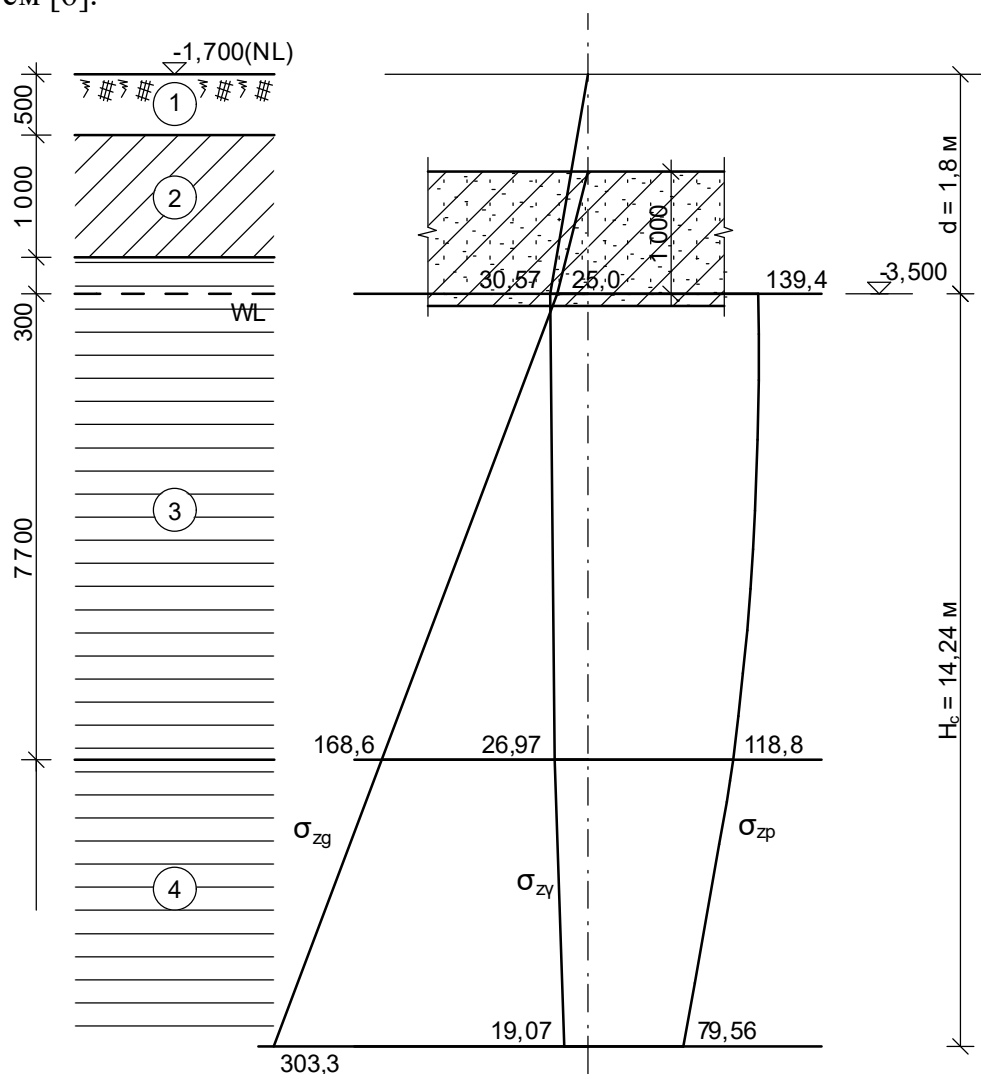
Схема розрахунку осідання плитного фундаменту
